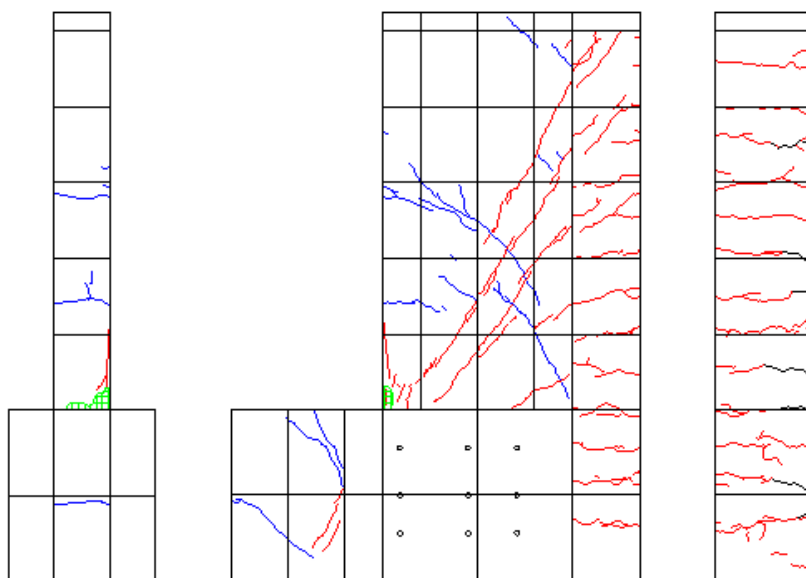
R=-1/100②ひび割れ図
